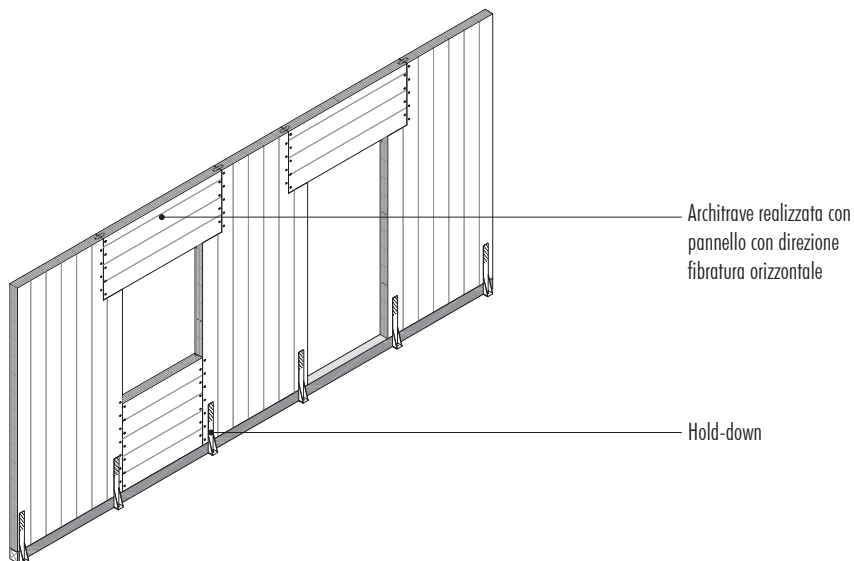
Dettaglio parete con aperture per porte e finestre.
